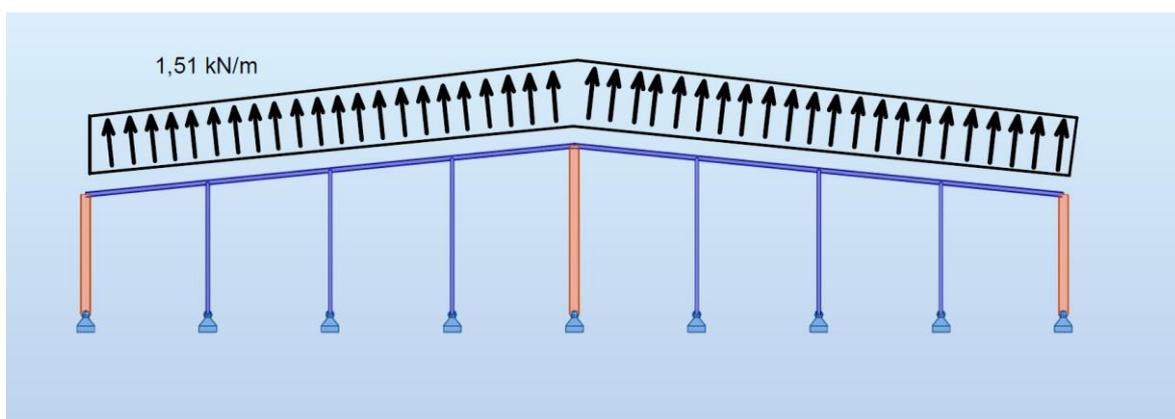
REPRESENTACIÓN PÓRTICO DE FACHADA EN ZONA I PARA CARGAS CON DIRECCIÓN LONGITUDINAL A CUBIERTA
